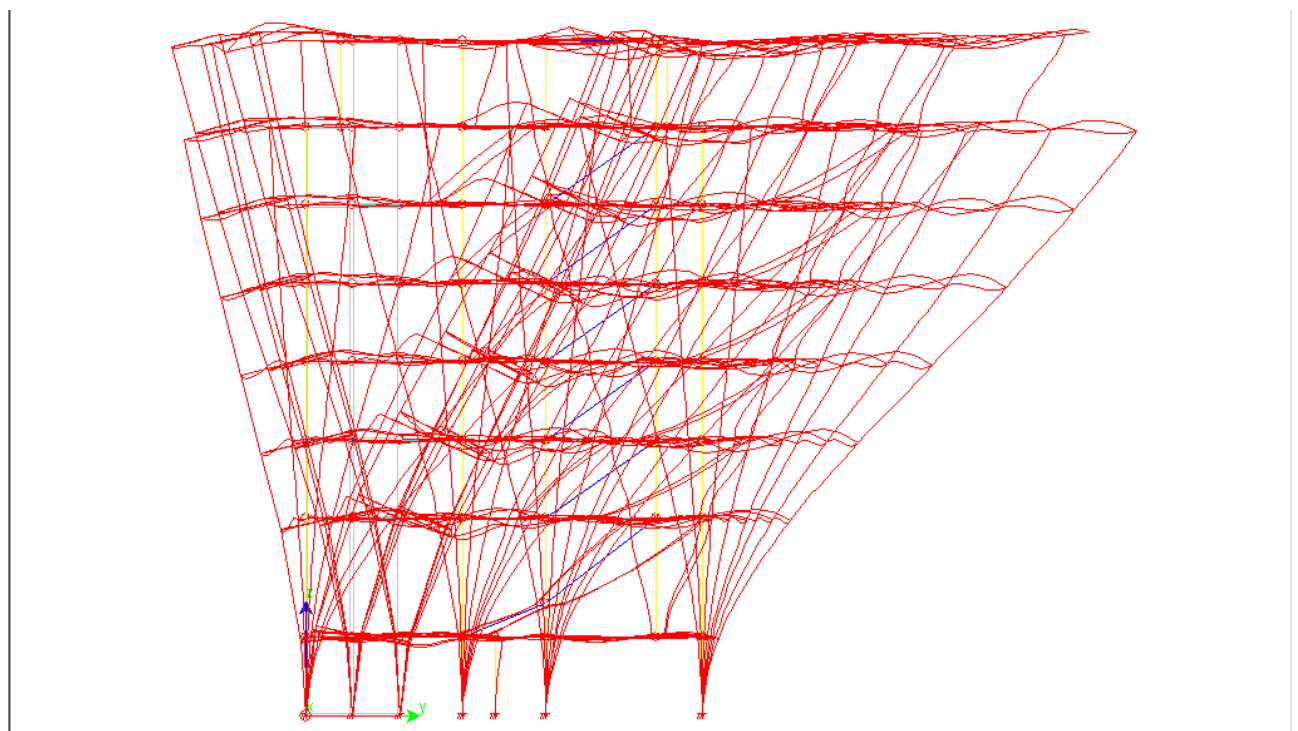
DEFORMATA DEL SECONDO MODO DI VIBRARE – PROSPETTO TRASVERSALE
